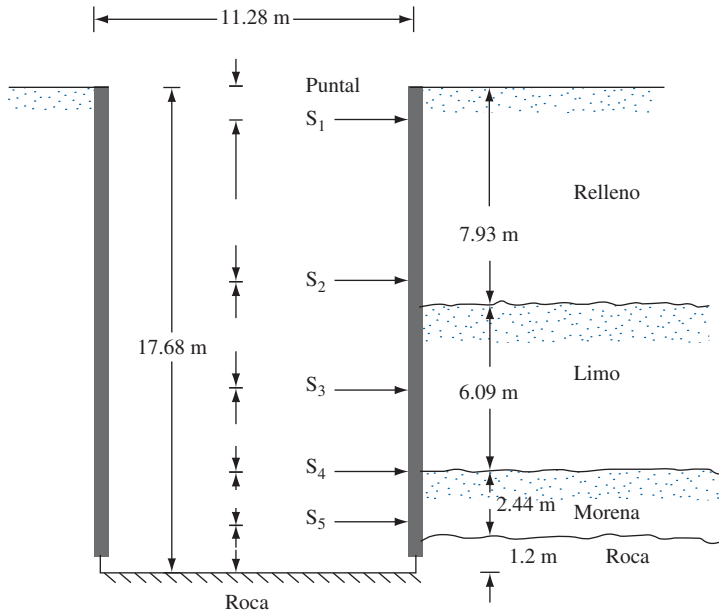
Diagrama esquemático de la sección de prueba B para la ampliación del metro, MTBA.
